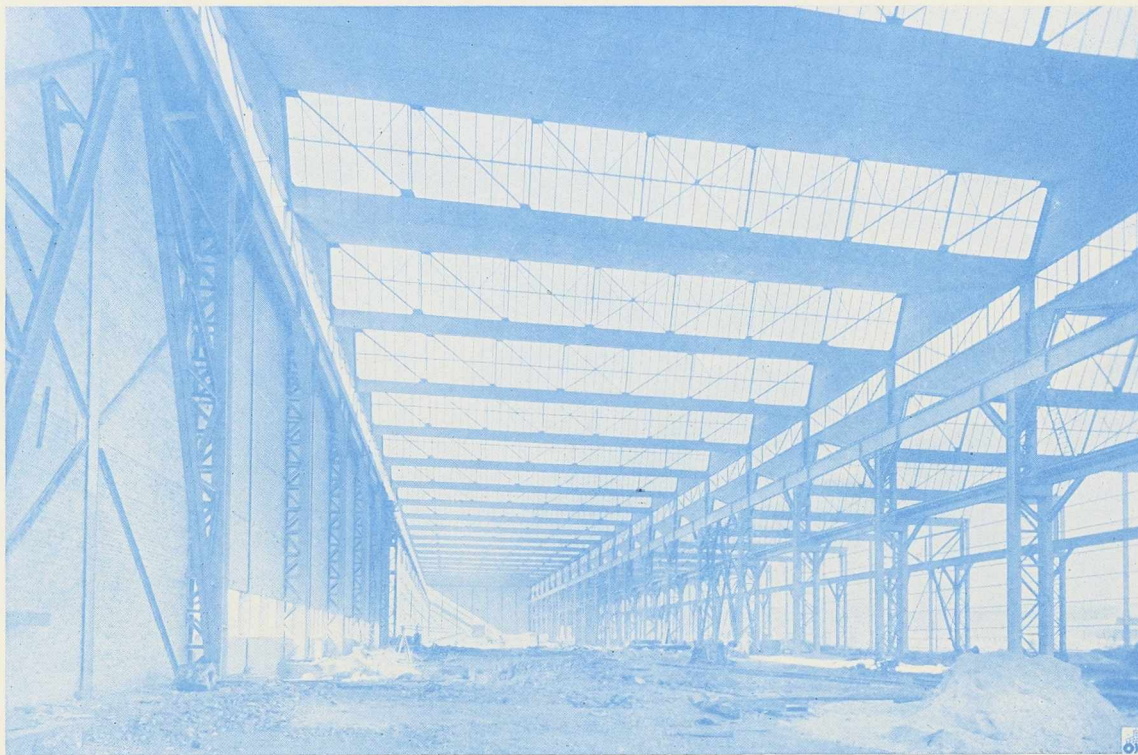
Vue intérieure du bâtiment de 31 mètres; à droite on aperçoit le bâtiment latéral de 20 mètres
